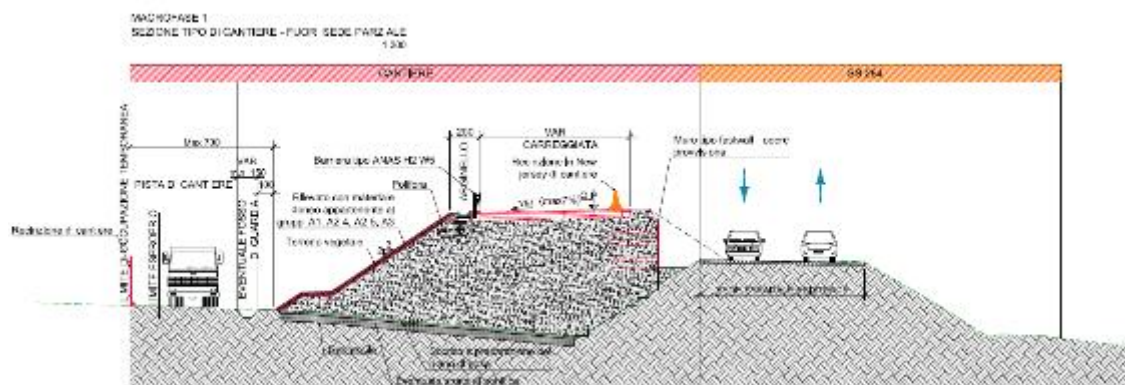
Intervento Fuori Sede Parziale (F.S.P.) – MACROFASE 1 - Sezione trasversale tipologica di cantierizzazione
